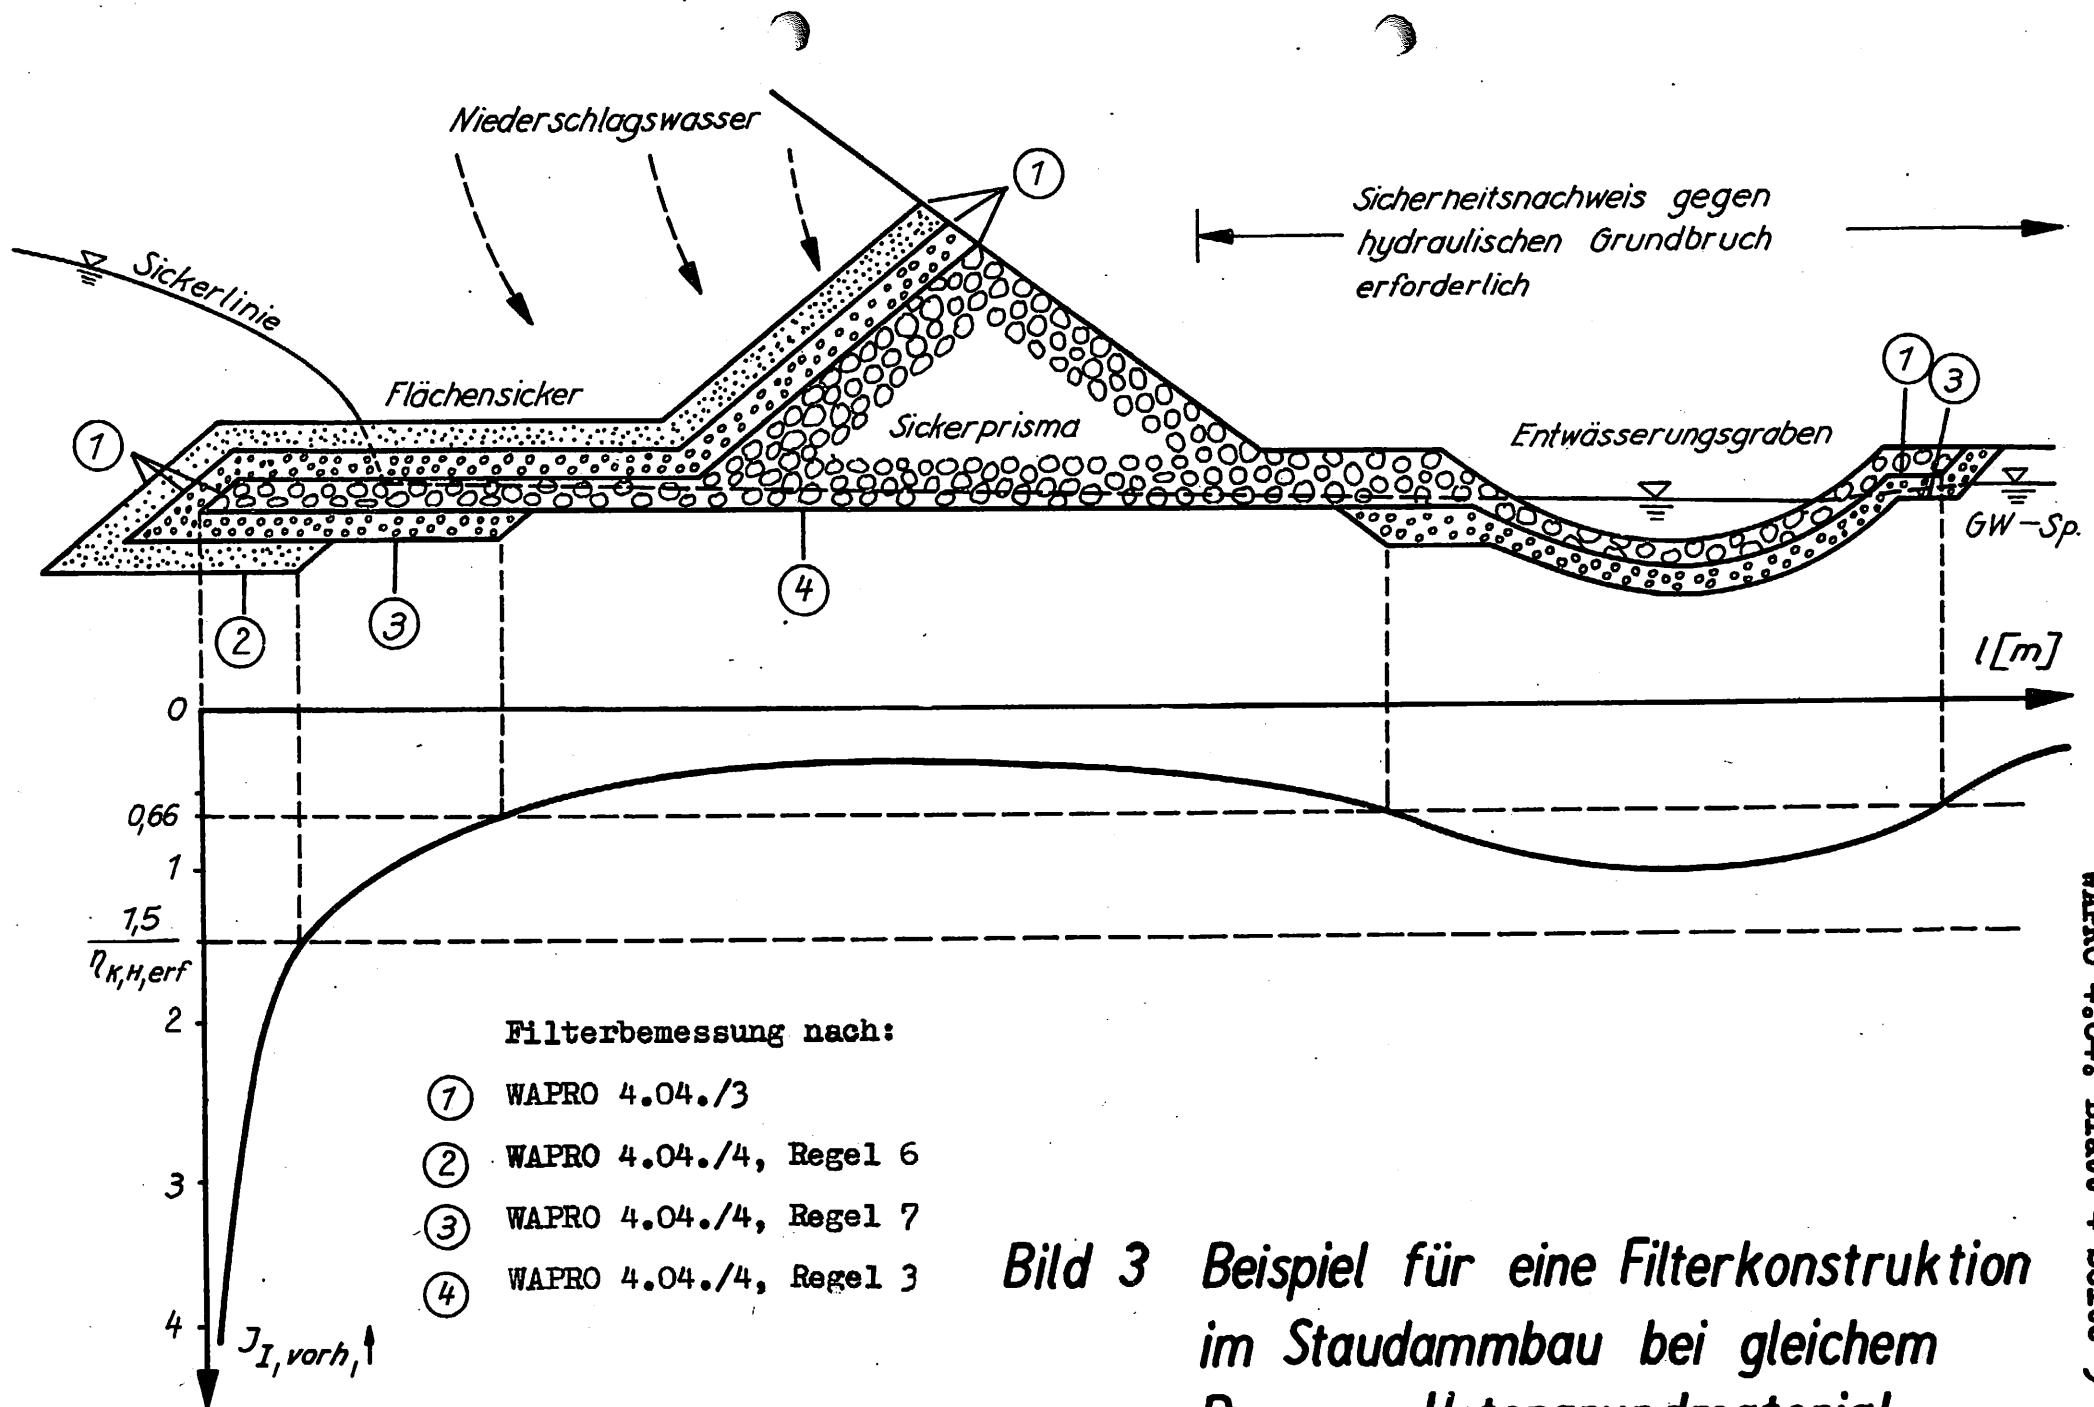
Beispiel für eine Filterkonstruktion im Staudammbau bei gleichem Damm - Untergrundmaterial
